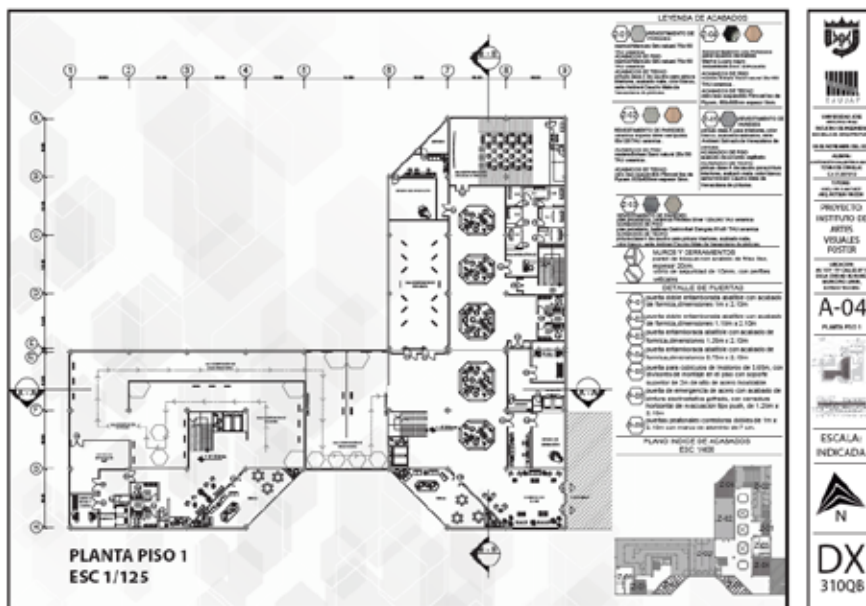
Plano de Planta Nivel 1. La autora (2020)
